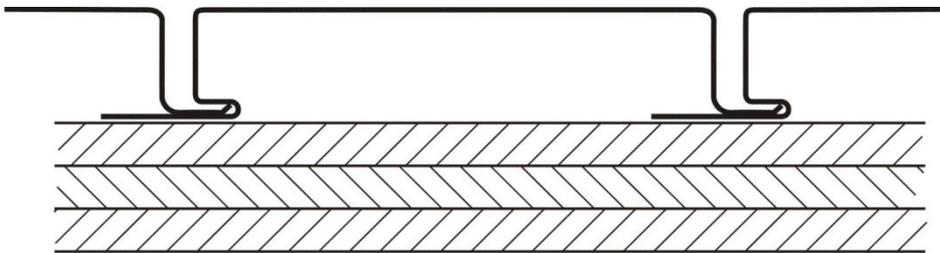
Coupe à travers une tôle profilée autoportante, fixée sur un support (panneaux à emboîtement).
